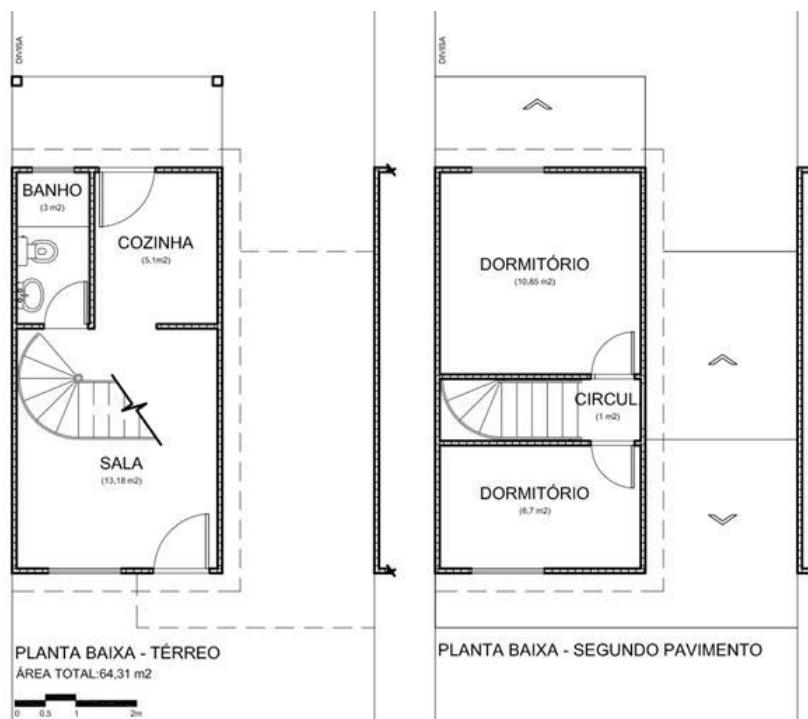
Planta baixa sobrado (baseada em prospecto de venda).
